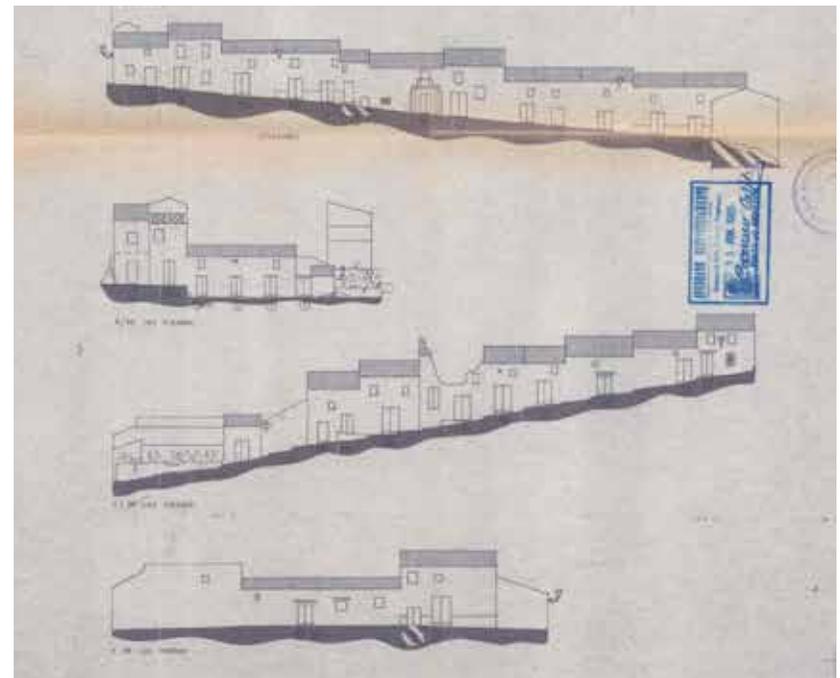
Alzados. Estudio de Manzana - NNS, plano IV.1.4.2. Fuente: Ayuntamiento de Gaucín, 1986
